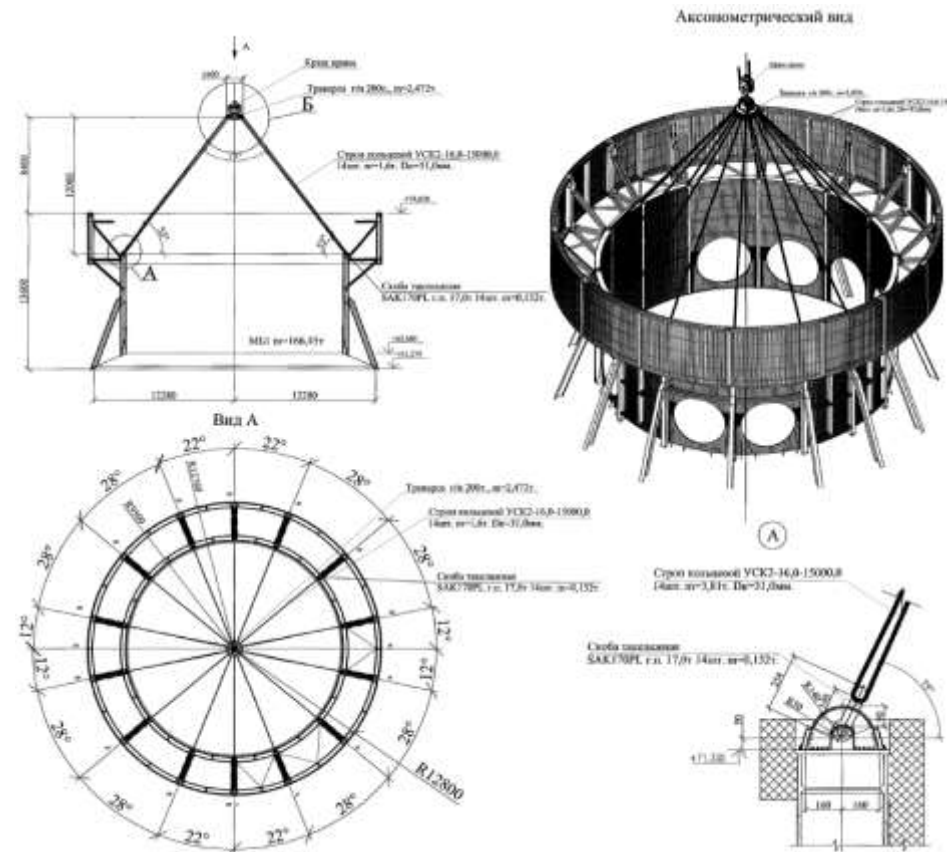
Схема строповки монтажного блока стальных строительных конструкций СПОТ (дефлектор) при монтаже
